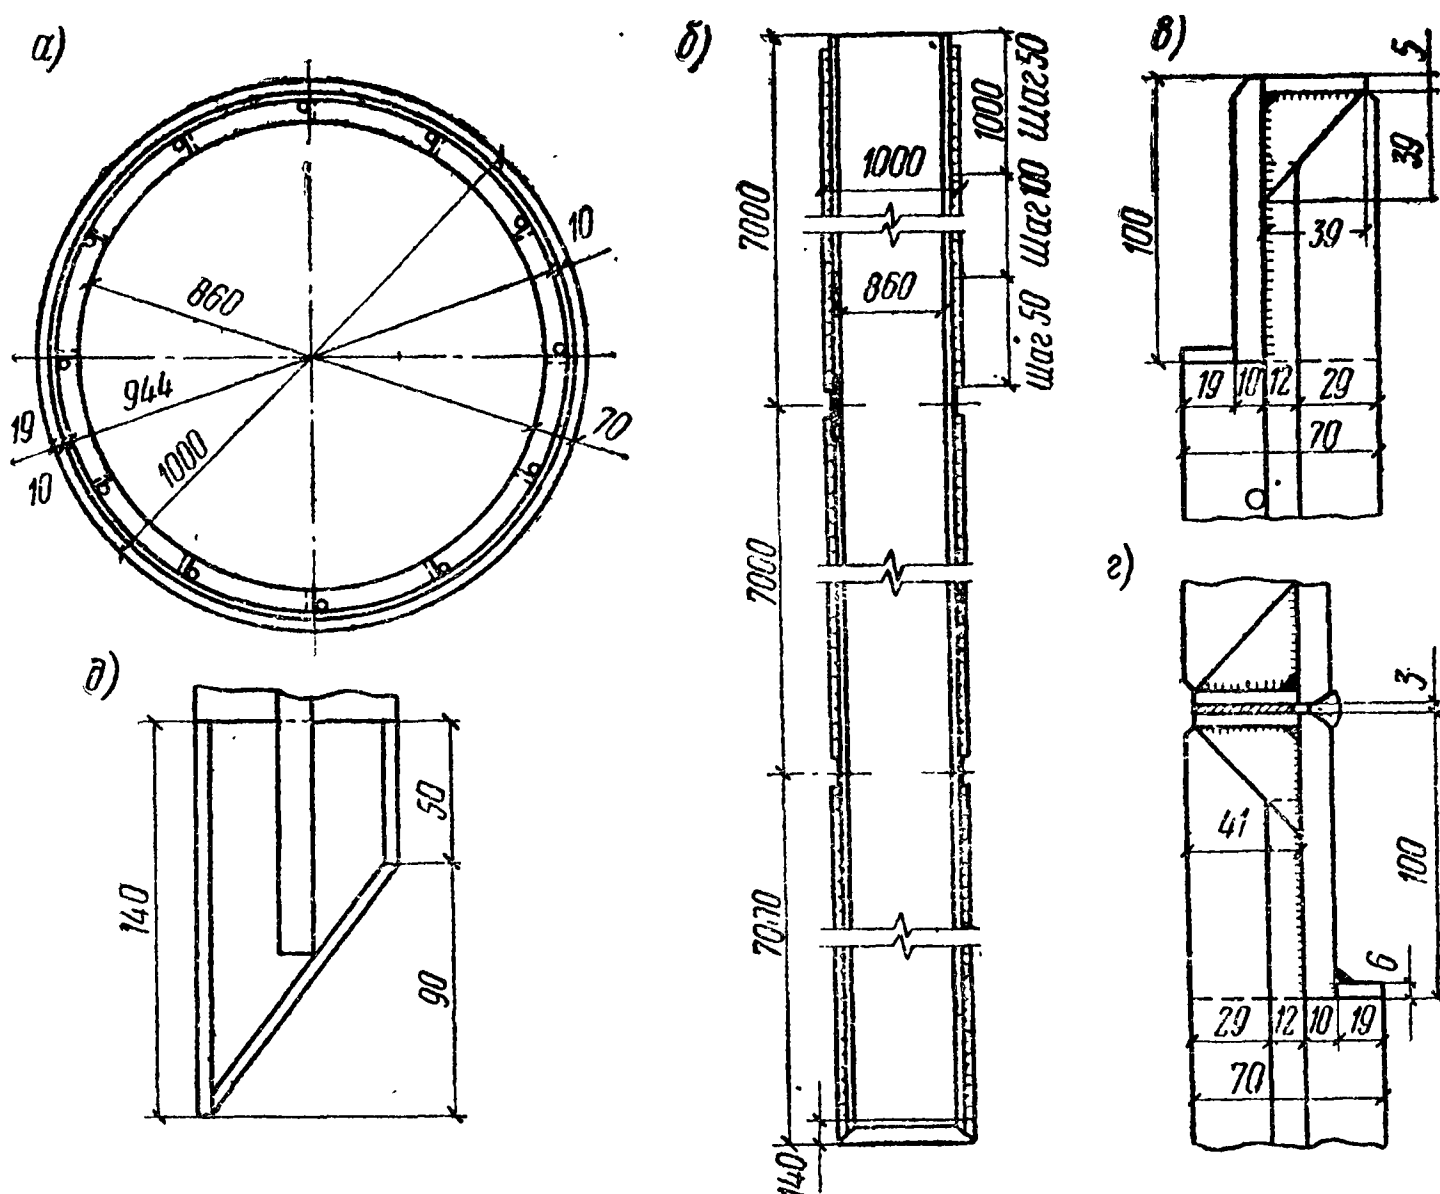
Железобетонная свая-оболочка диаметром 100 см с ненапрягаемой арматурой
